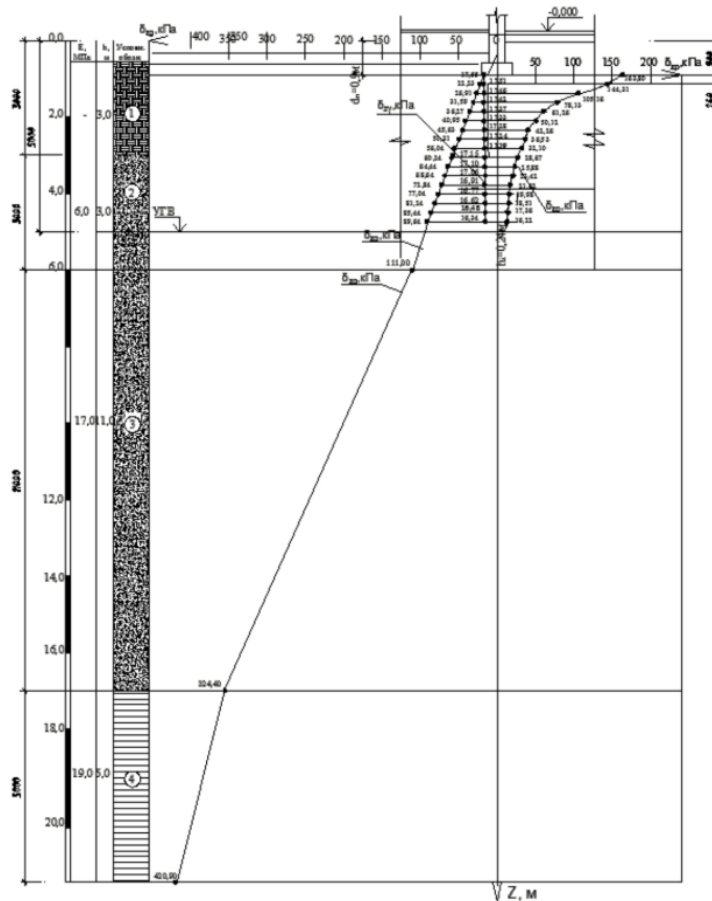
осадки внутрішнього стрічкового фундаменту
